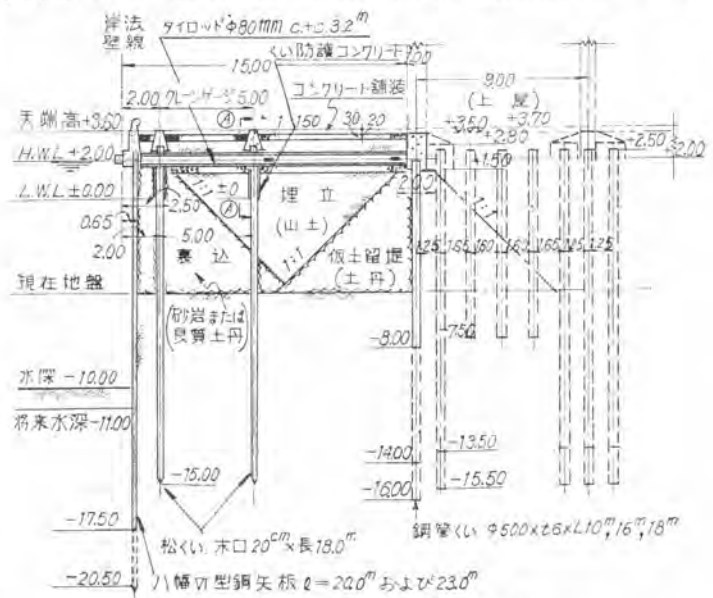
山下埠頭Z型鋼矢板岩盤標準断面図
